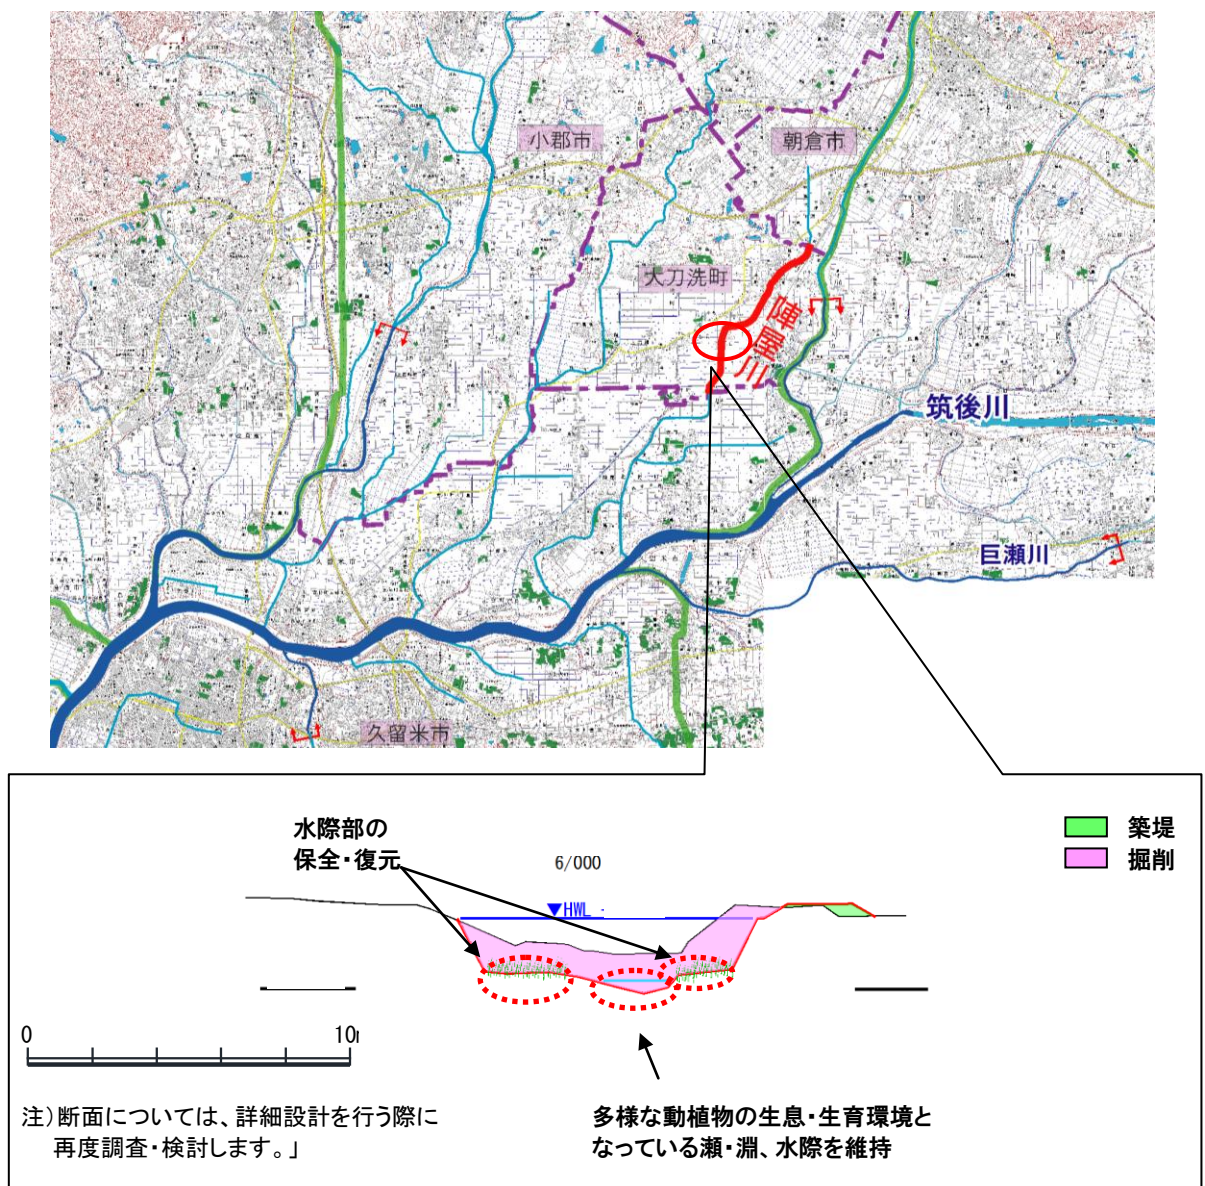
陣屋川 整備計画区間平面図・代表横断面図
